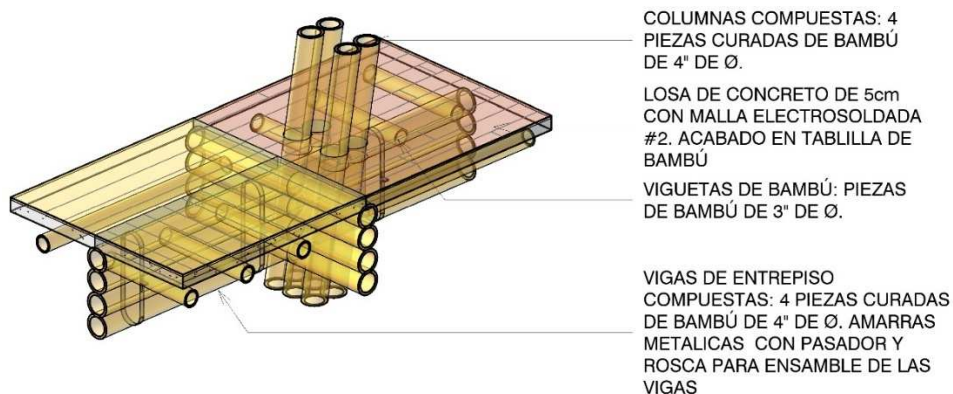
Detalle de cimentaciones y componentes estructurales del anteproyecto esquemático de estructura en bambú. Fuente: Elaborada por el autor.
